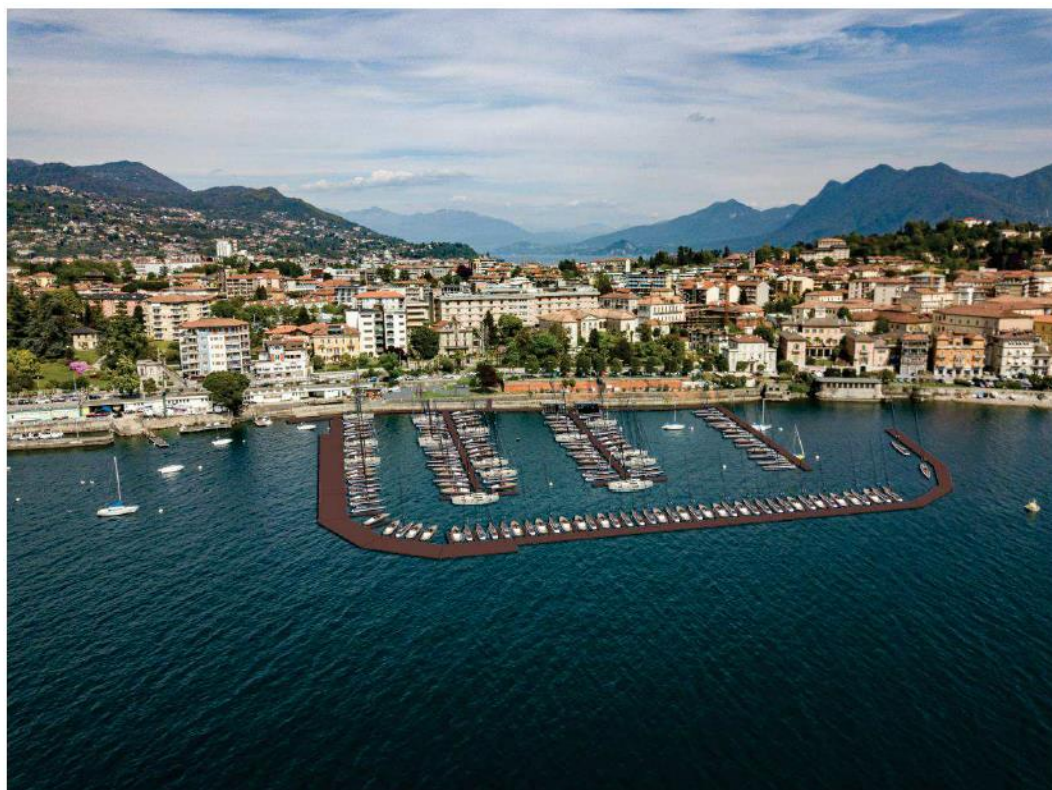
Fotoinserimento dal lago verso Pallanza
